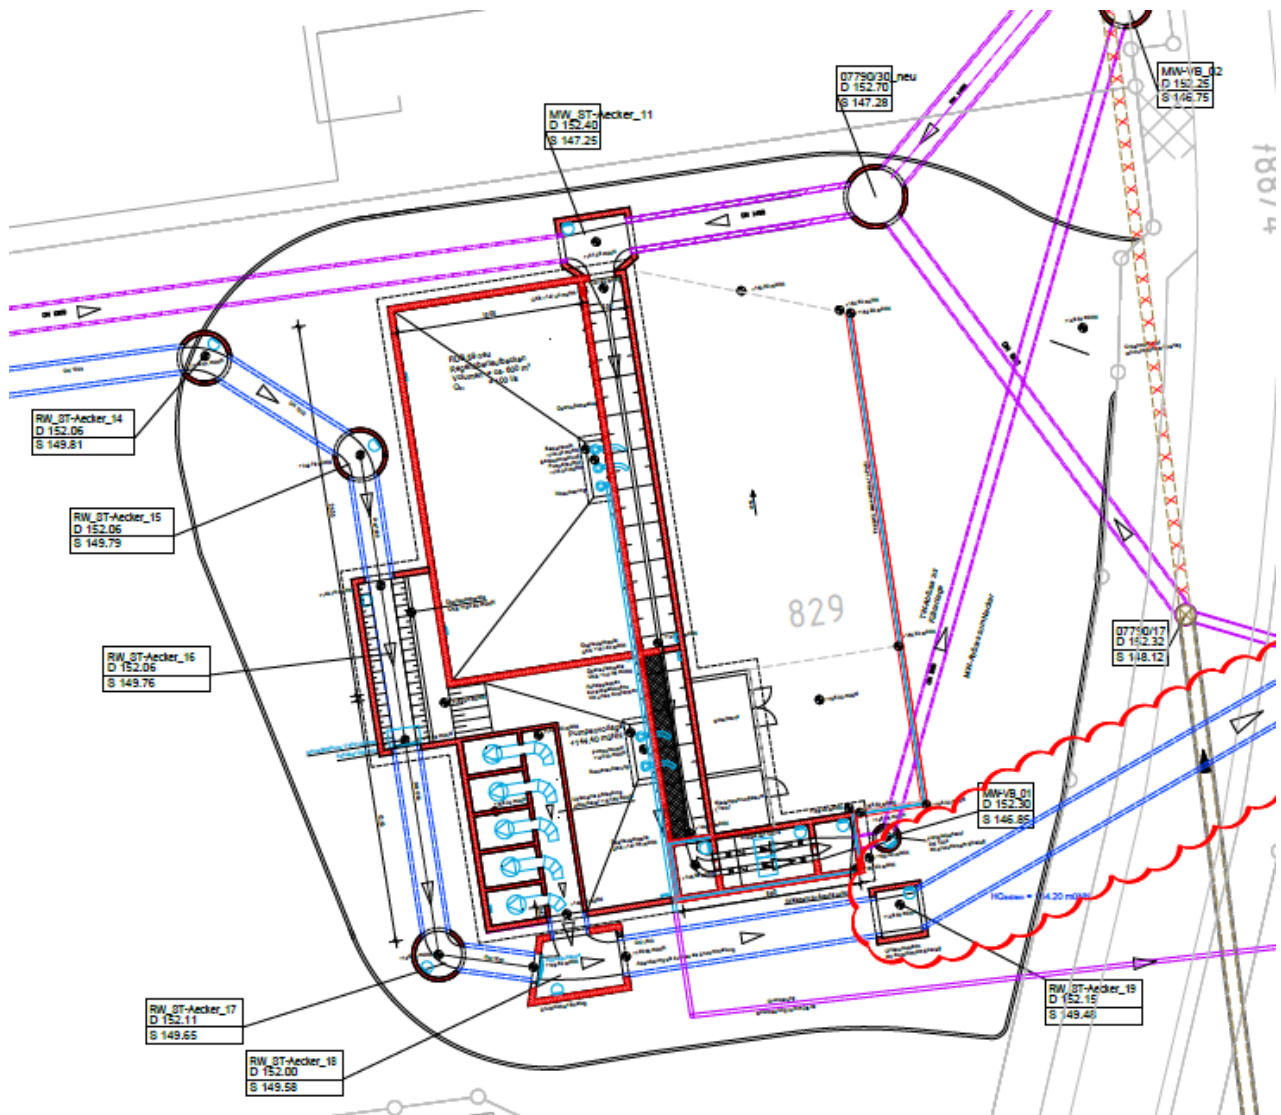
Bauwerksplan (Grundriß) RÜB 59 neu
